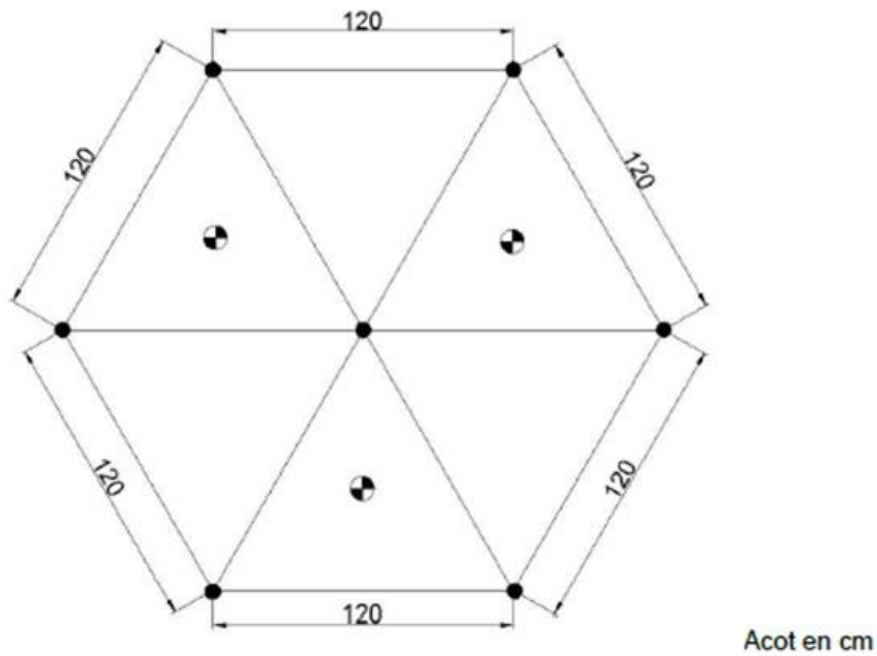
Ubicación en planta de los tres piezómetros adicionales
